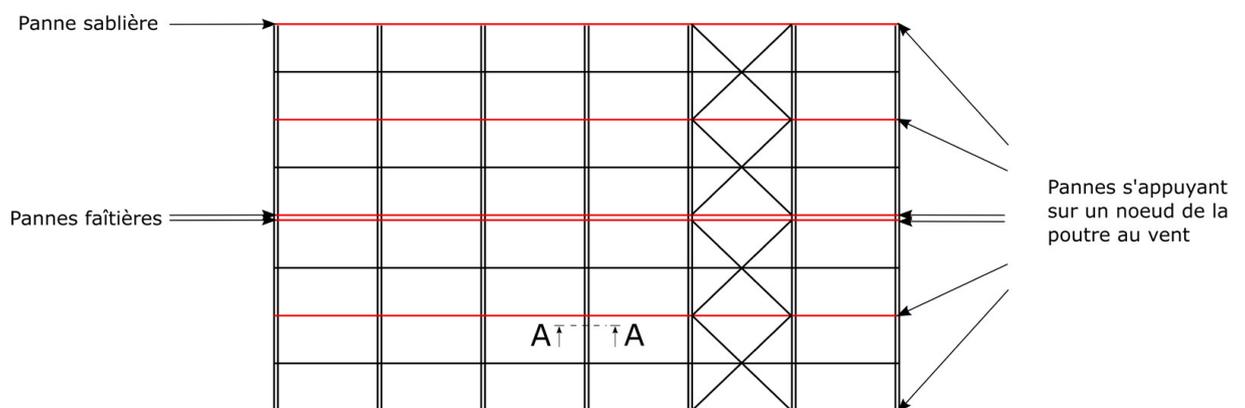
Maintien des semelles de la traverse – Vue en plan
